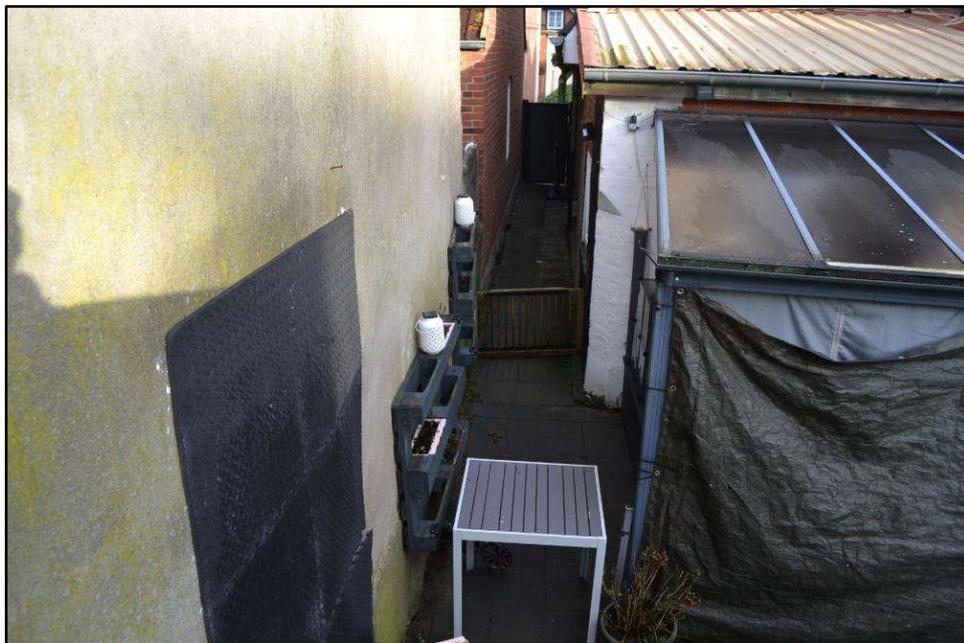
Blick zwischen Nachbargrundstück und Wohnhaus nach Norden zur Neuwerkstraße
